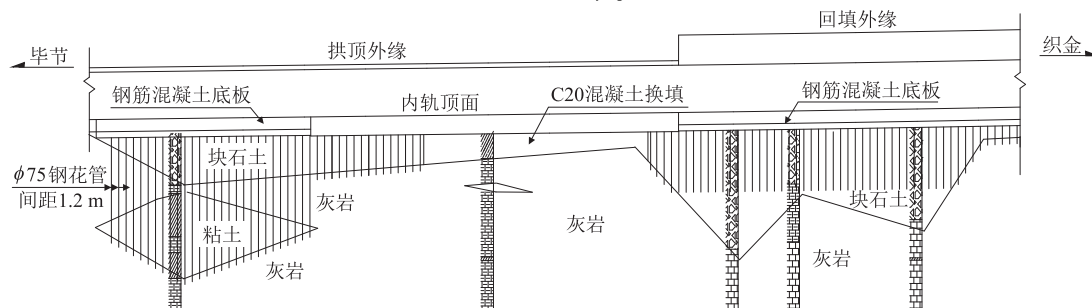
DK 364 + 225 ~ DK 364 + 370 隧底注浆纵断面示意图
